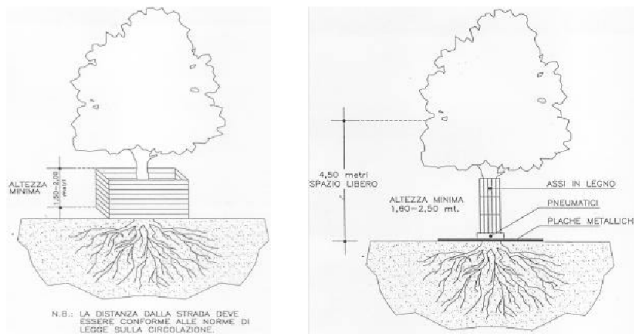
Protezione dell'albero attraverso la delimitazione dell'area minima di rispetto per alberature stradali con poco spazio.
